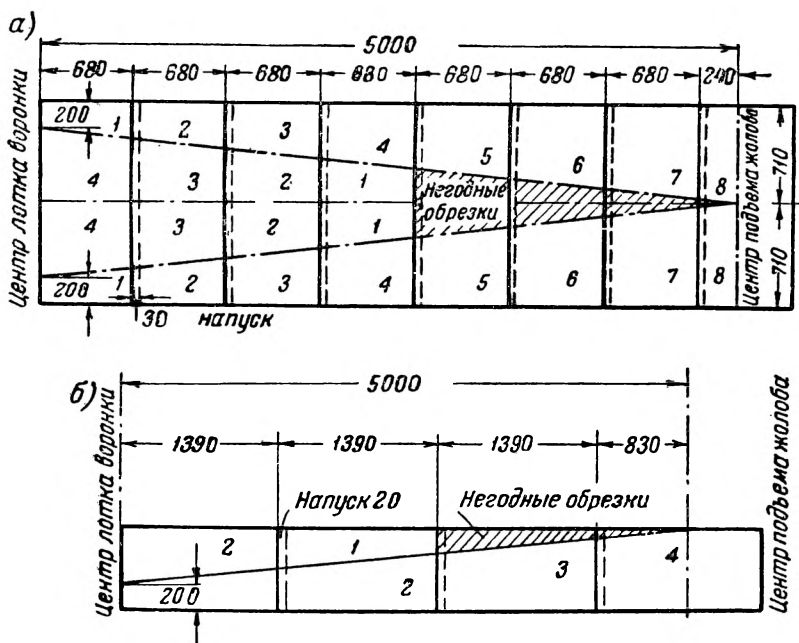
Разметка листов для заготовки покрытия карнизного свеса:
